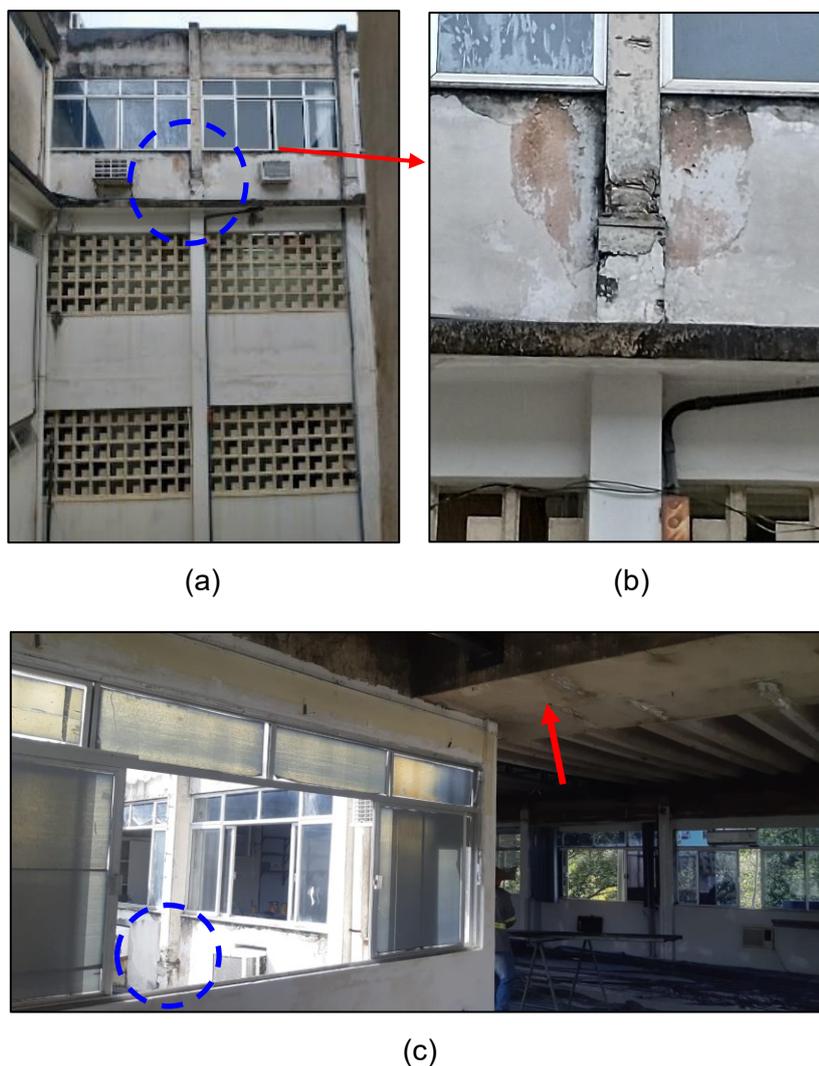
Viga transversal (seta) apoiada em pilares com alto grau de deterioração (assinalados): a) vista interna; b) vista externa do pilar assinalado; c) detalhe do pilar.
